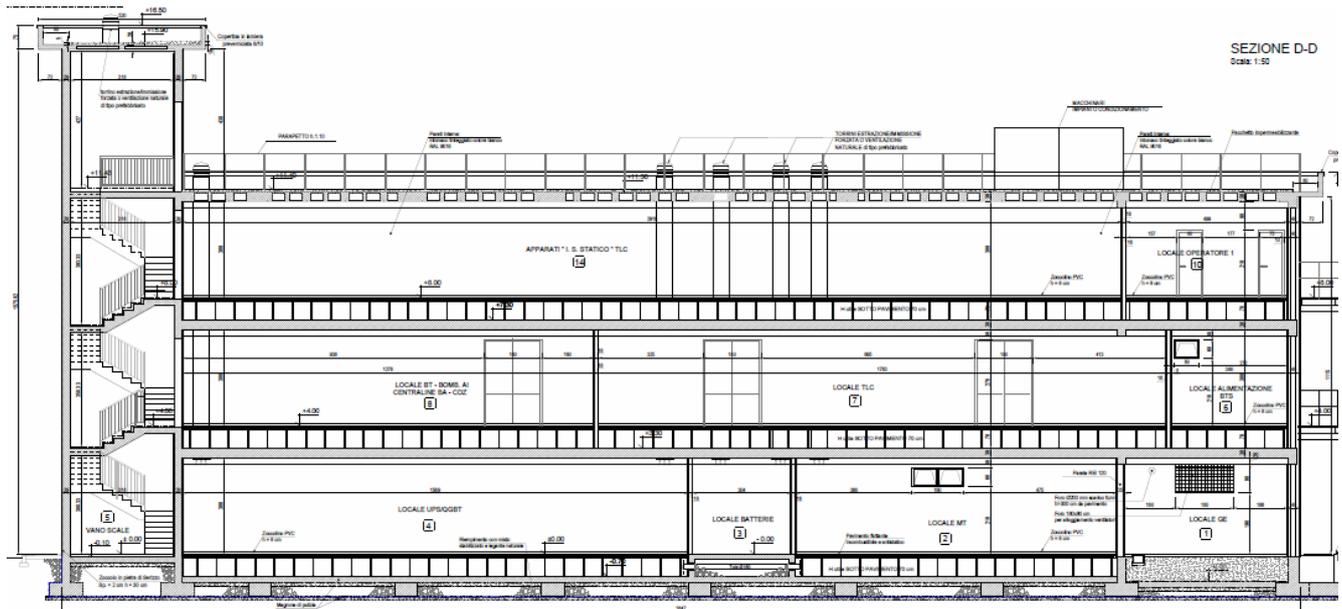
Stralcio sezione longitudinale del fabbricato.
